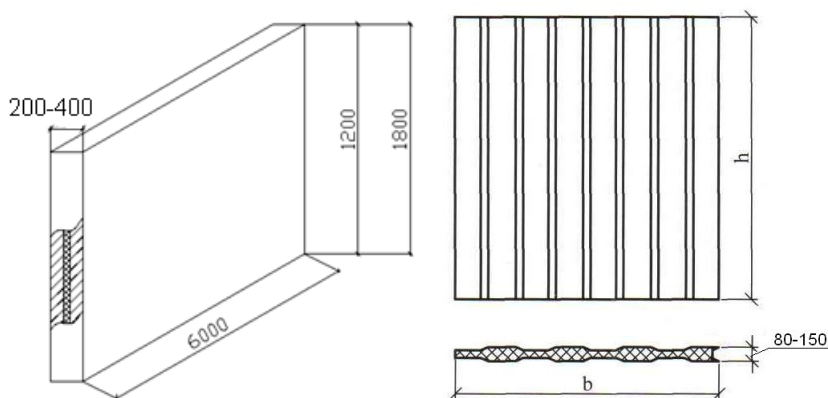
Стеновые панели: железобетонные и типа «сэндвич»
